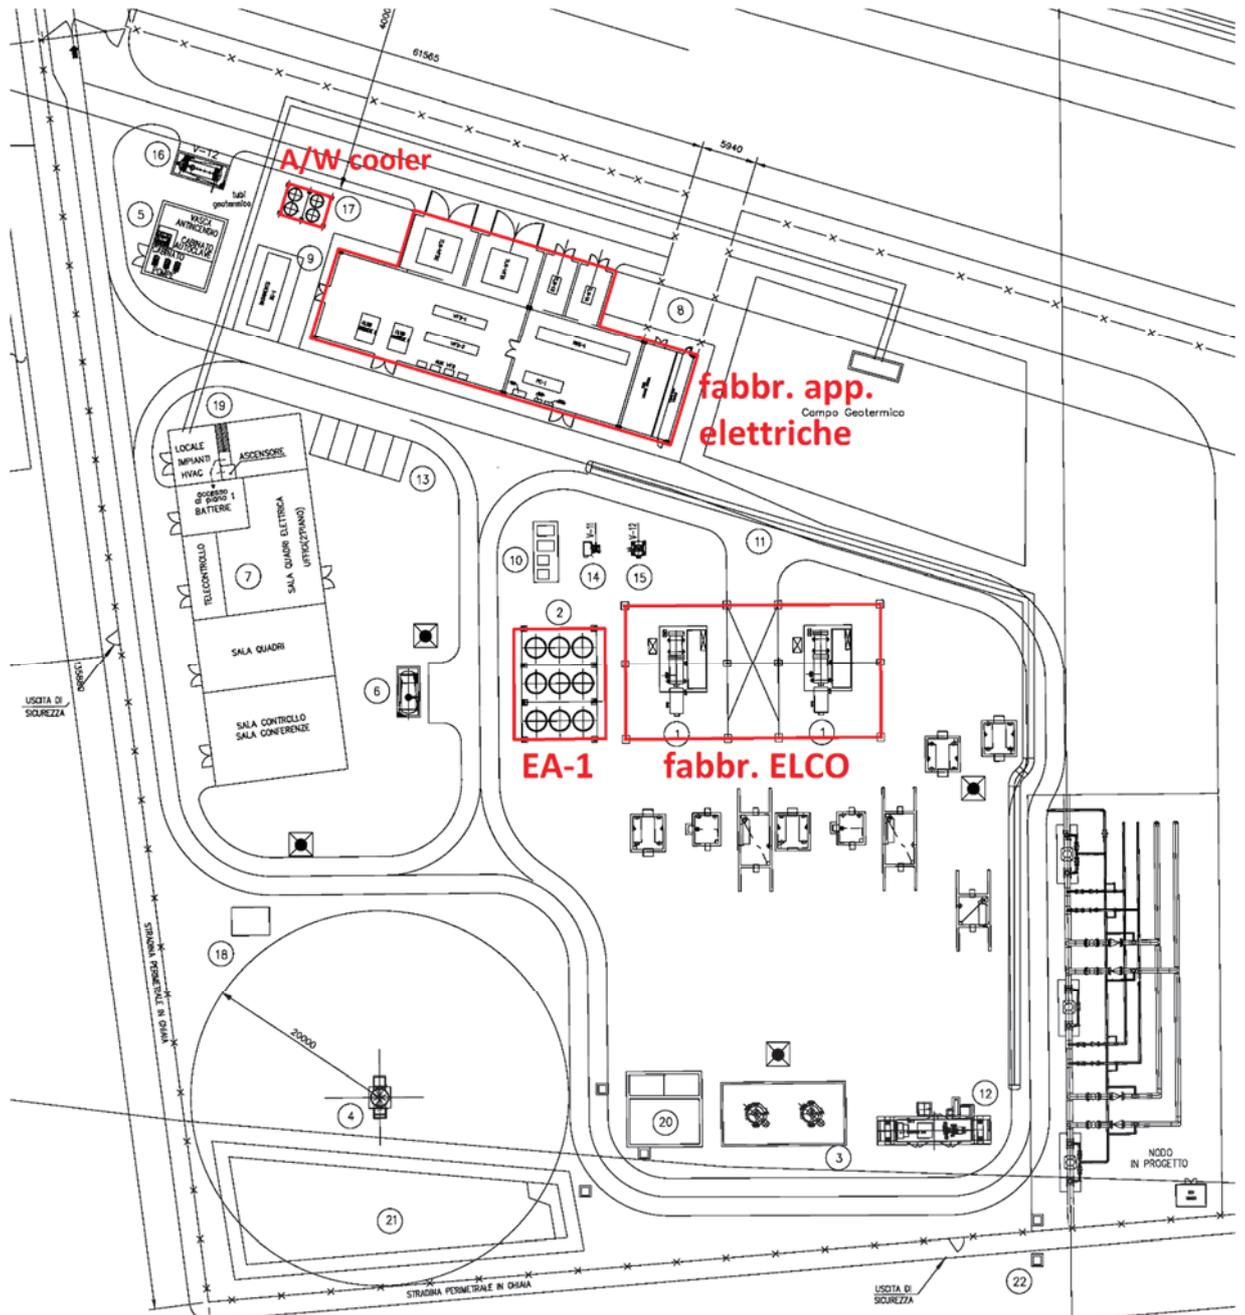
Stralcio della planimetria della stazione di spinta con la localizzazione delle sorgenti rumorose continue esaminate (in rosso).
